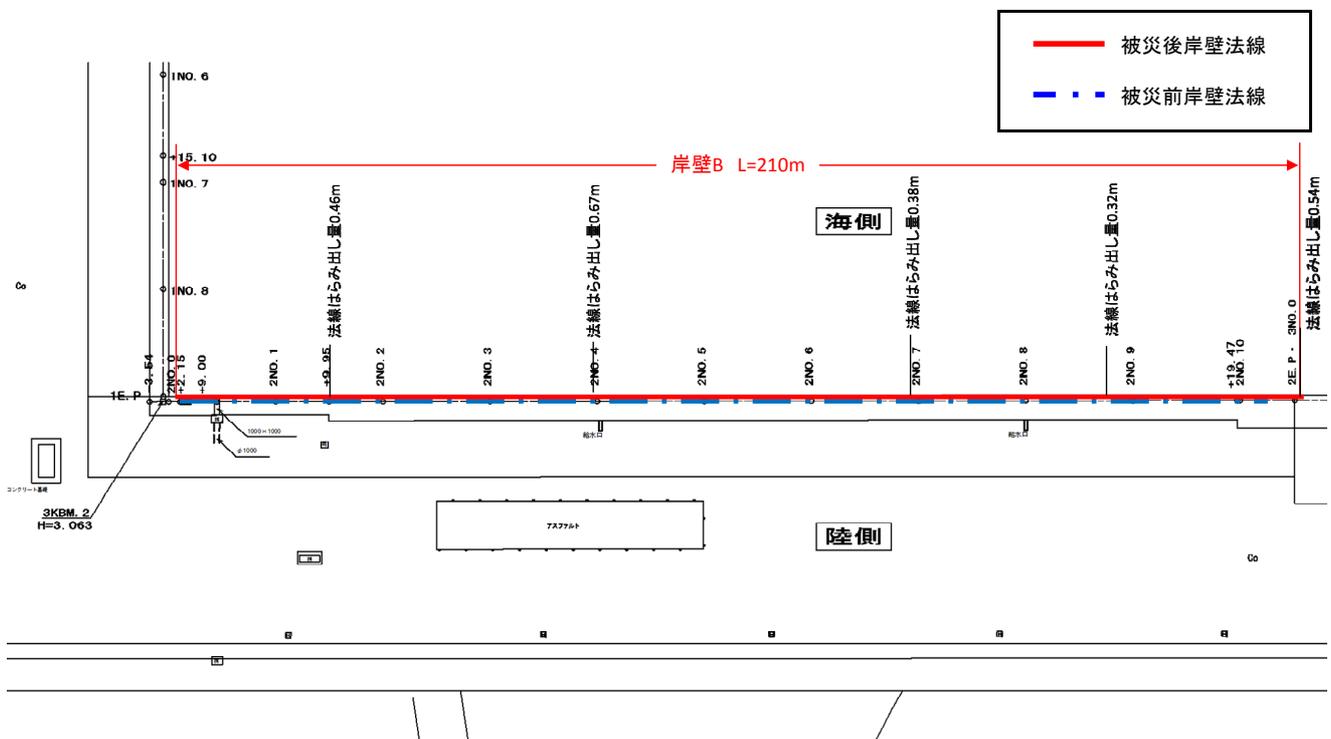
No.22 常陸那珂港区_南埠頭地区 B岸壁 (-5.5m) の平面図 (被災後)
